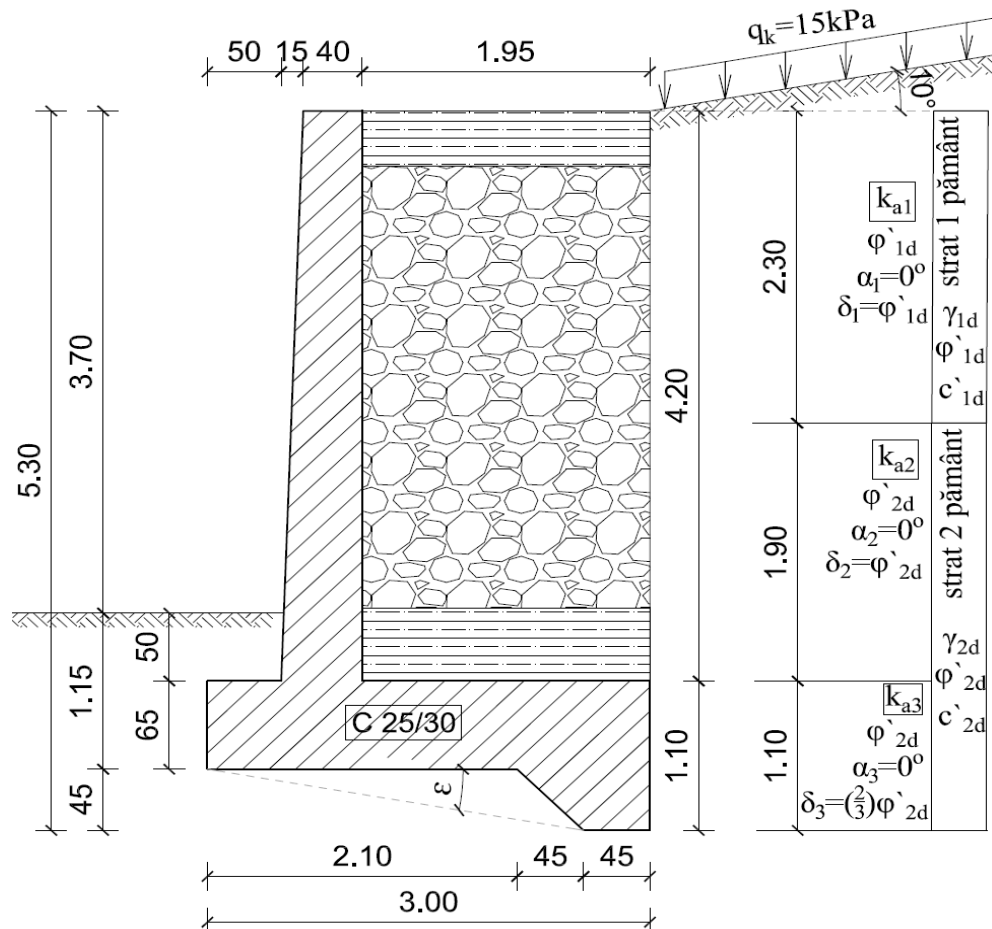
Predimensionare și conformare zid de sprijin din beton armat (exemplu 2)
